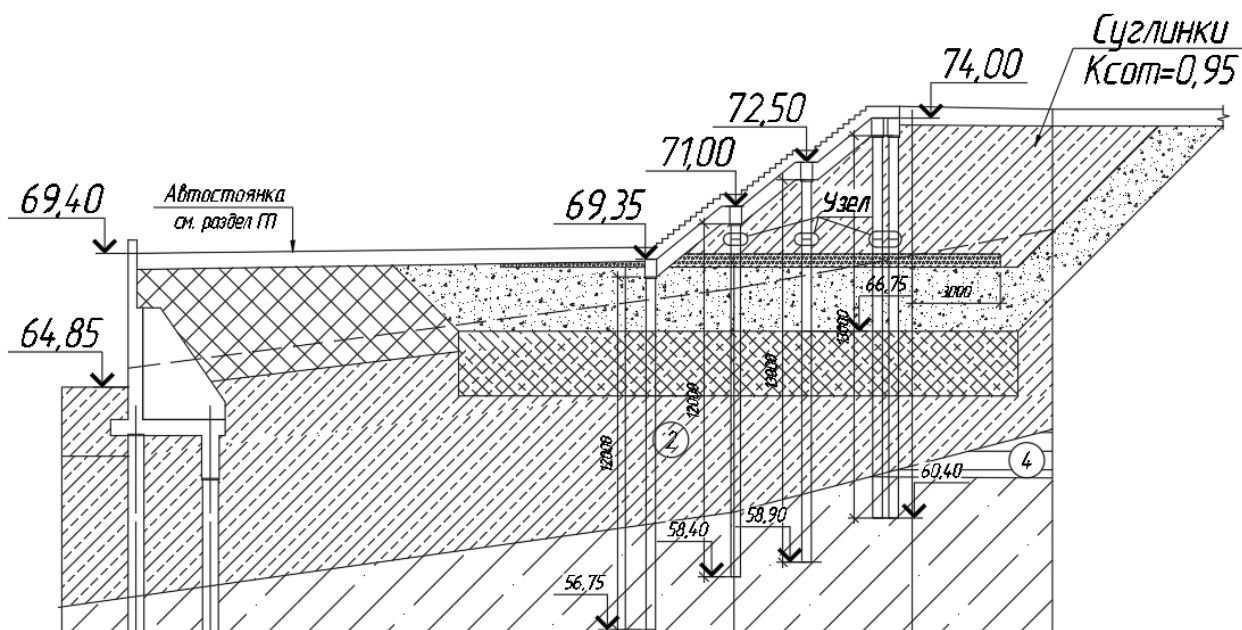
Железобетонный косоур на сваях в теле насыпи
